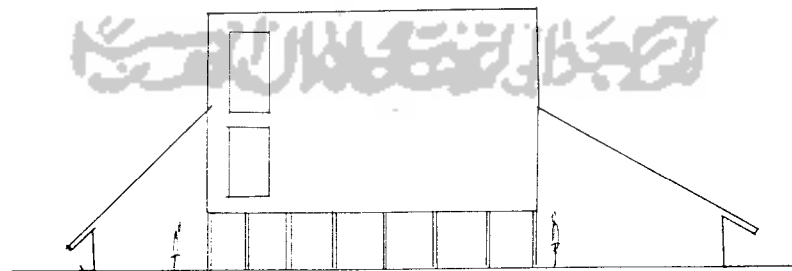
Sketsa Fasade Bangunan Massa Lampau dan Modern
